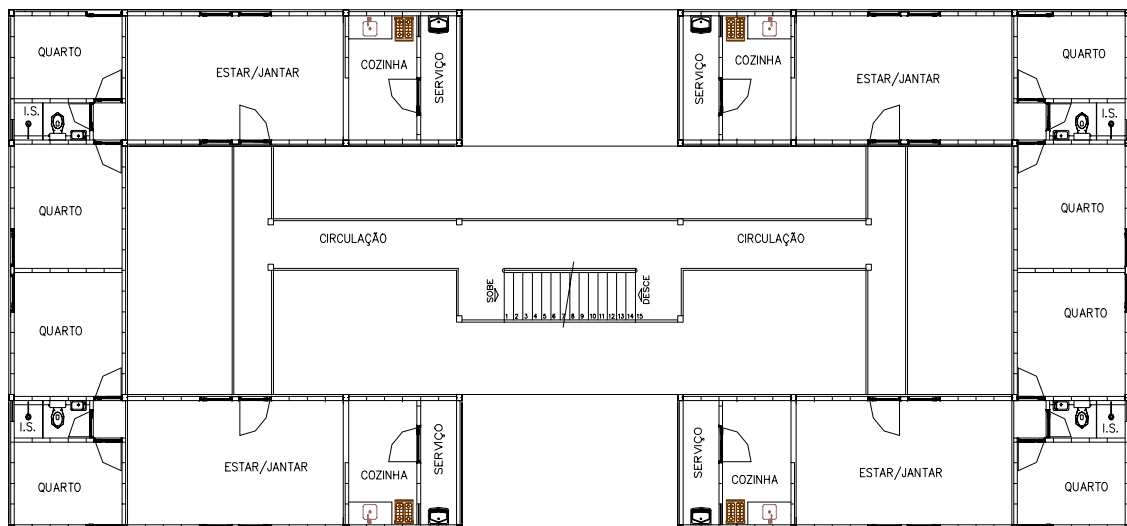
Planta Baixa do 1º, 2º e 4º pavimentos do Projeto 02 (Protótipo USIHAB, 2001).
